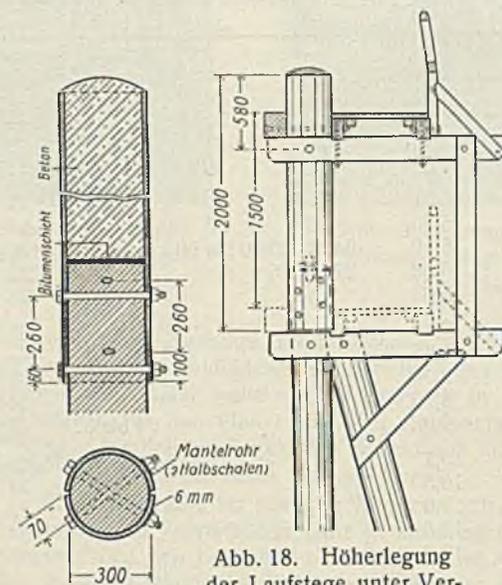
Höherlegung der Laufstege unter Verlängerung der senkrechten Holzpfähle mit eisernen Halbschalen.
